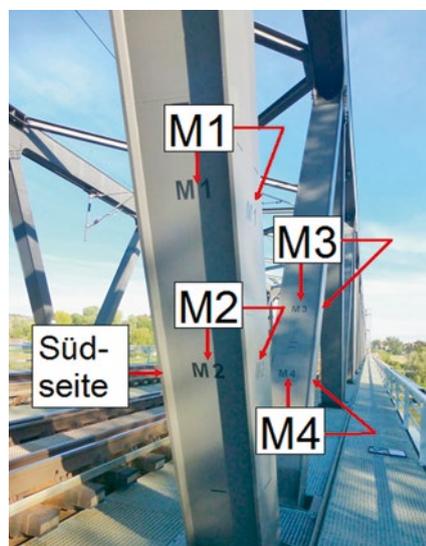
> Musterflächen M1 bis M4 mit vier alternativen Beschichtungssystemen am Tragwerk.
